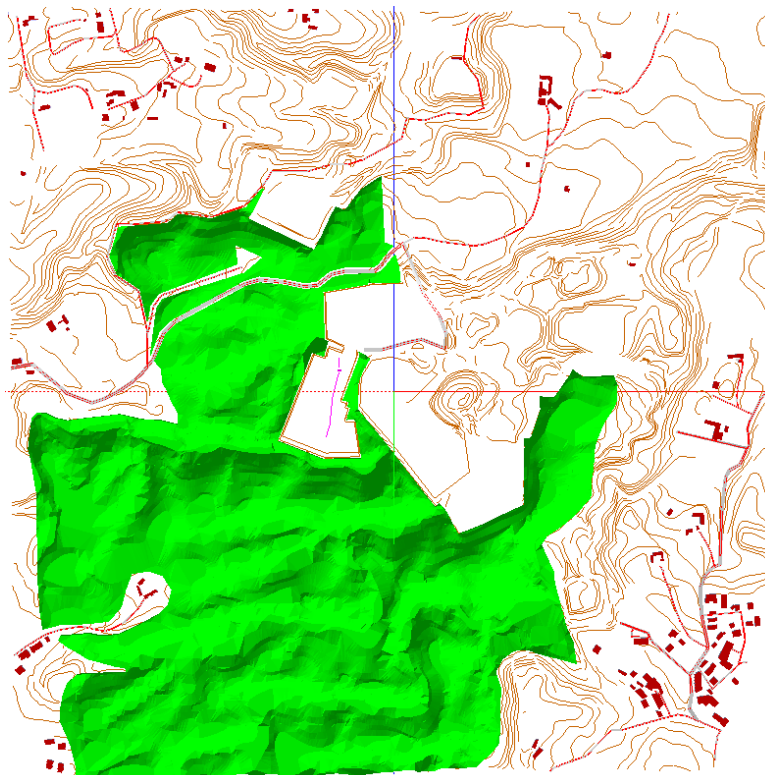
Modellizzazione DGM– Rappresentazione planimetrica
